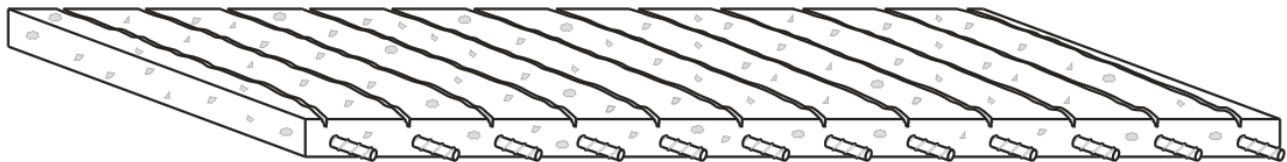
Fisuras por asentamiento plástico, causadas por bajo recubrimiento y/o alta fluidez.
